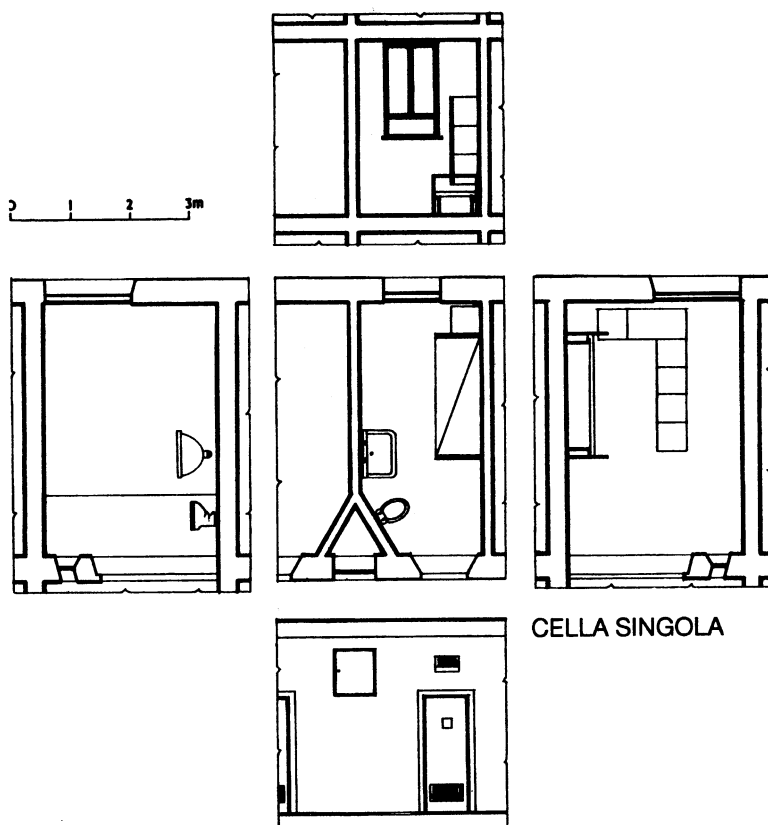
Arch. S. Lenci - Pianta e sezione cella singola
